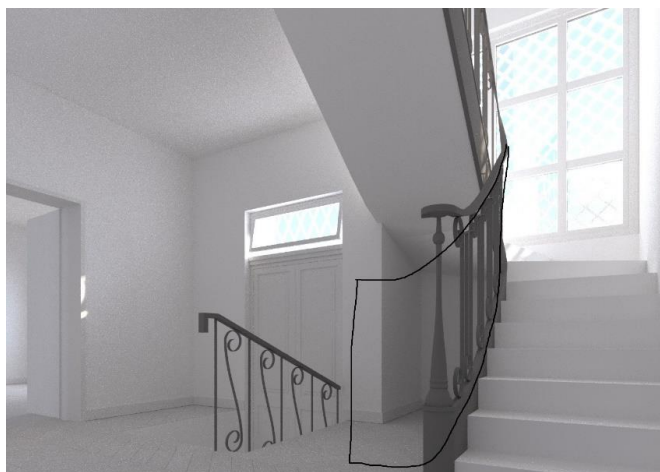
Teste estrutural. Fonte: Yoan Guerreiro
